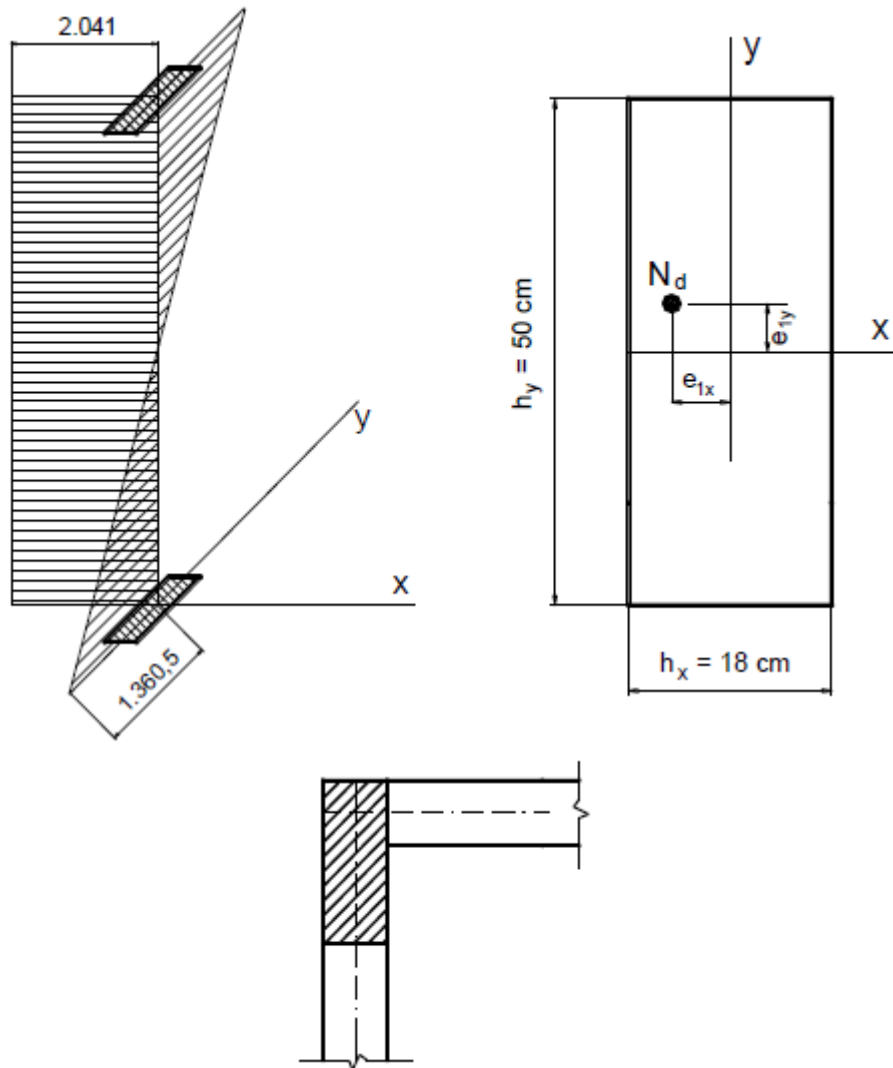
Arranjo estrutural do pilar na planta de fôrma, dimensões da seção transversal e posição do ponto de aplicação da força normal N_d .
